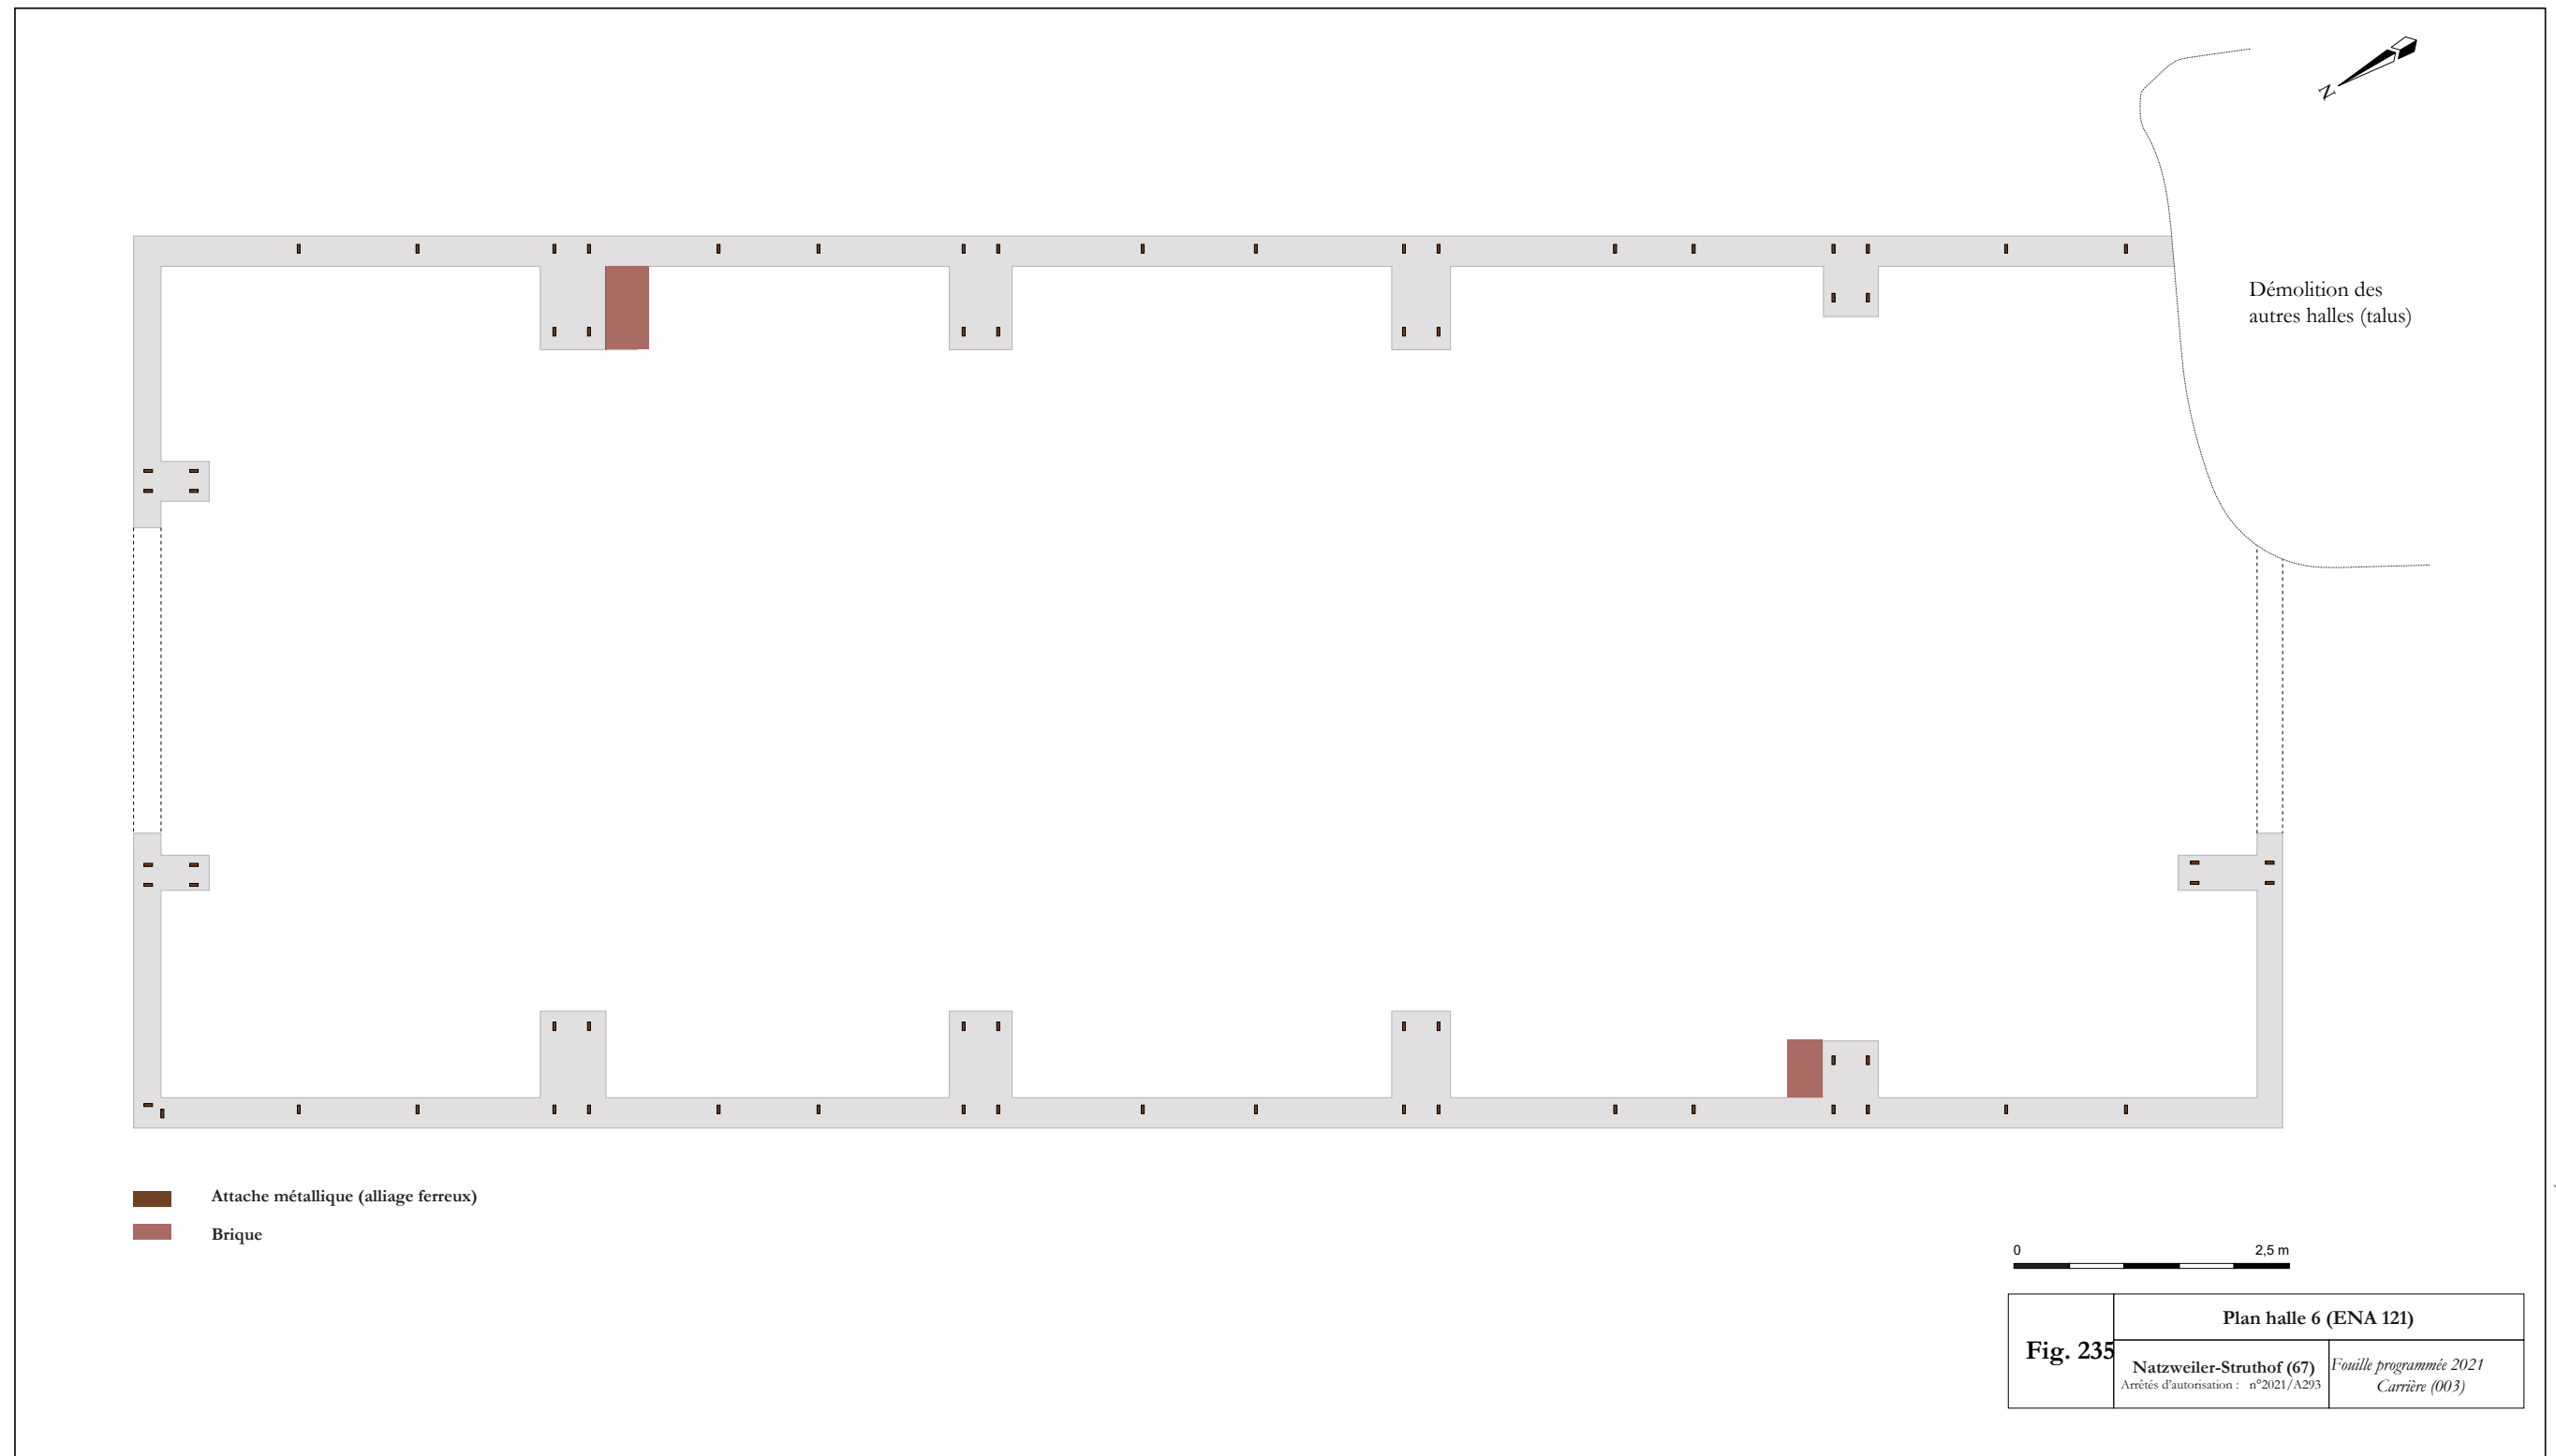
Plan de la halle 6, ENA 121 (DAO : T. Aubry et J. Brangé).
